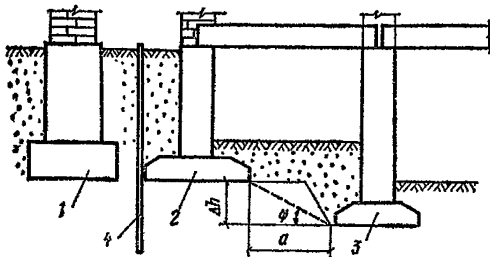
Схема защиты существующего здания от дополнительных осадок при воздействии рядом нового здания с большей глубиной заложения фундаментов
